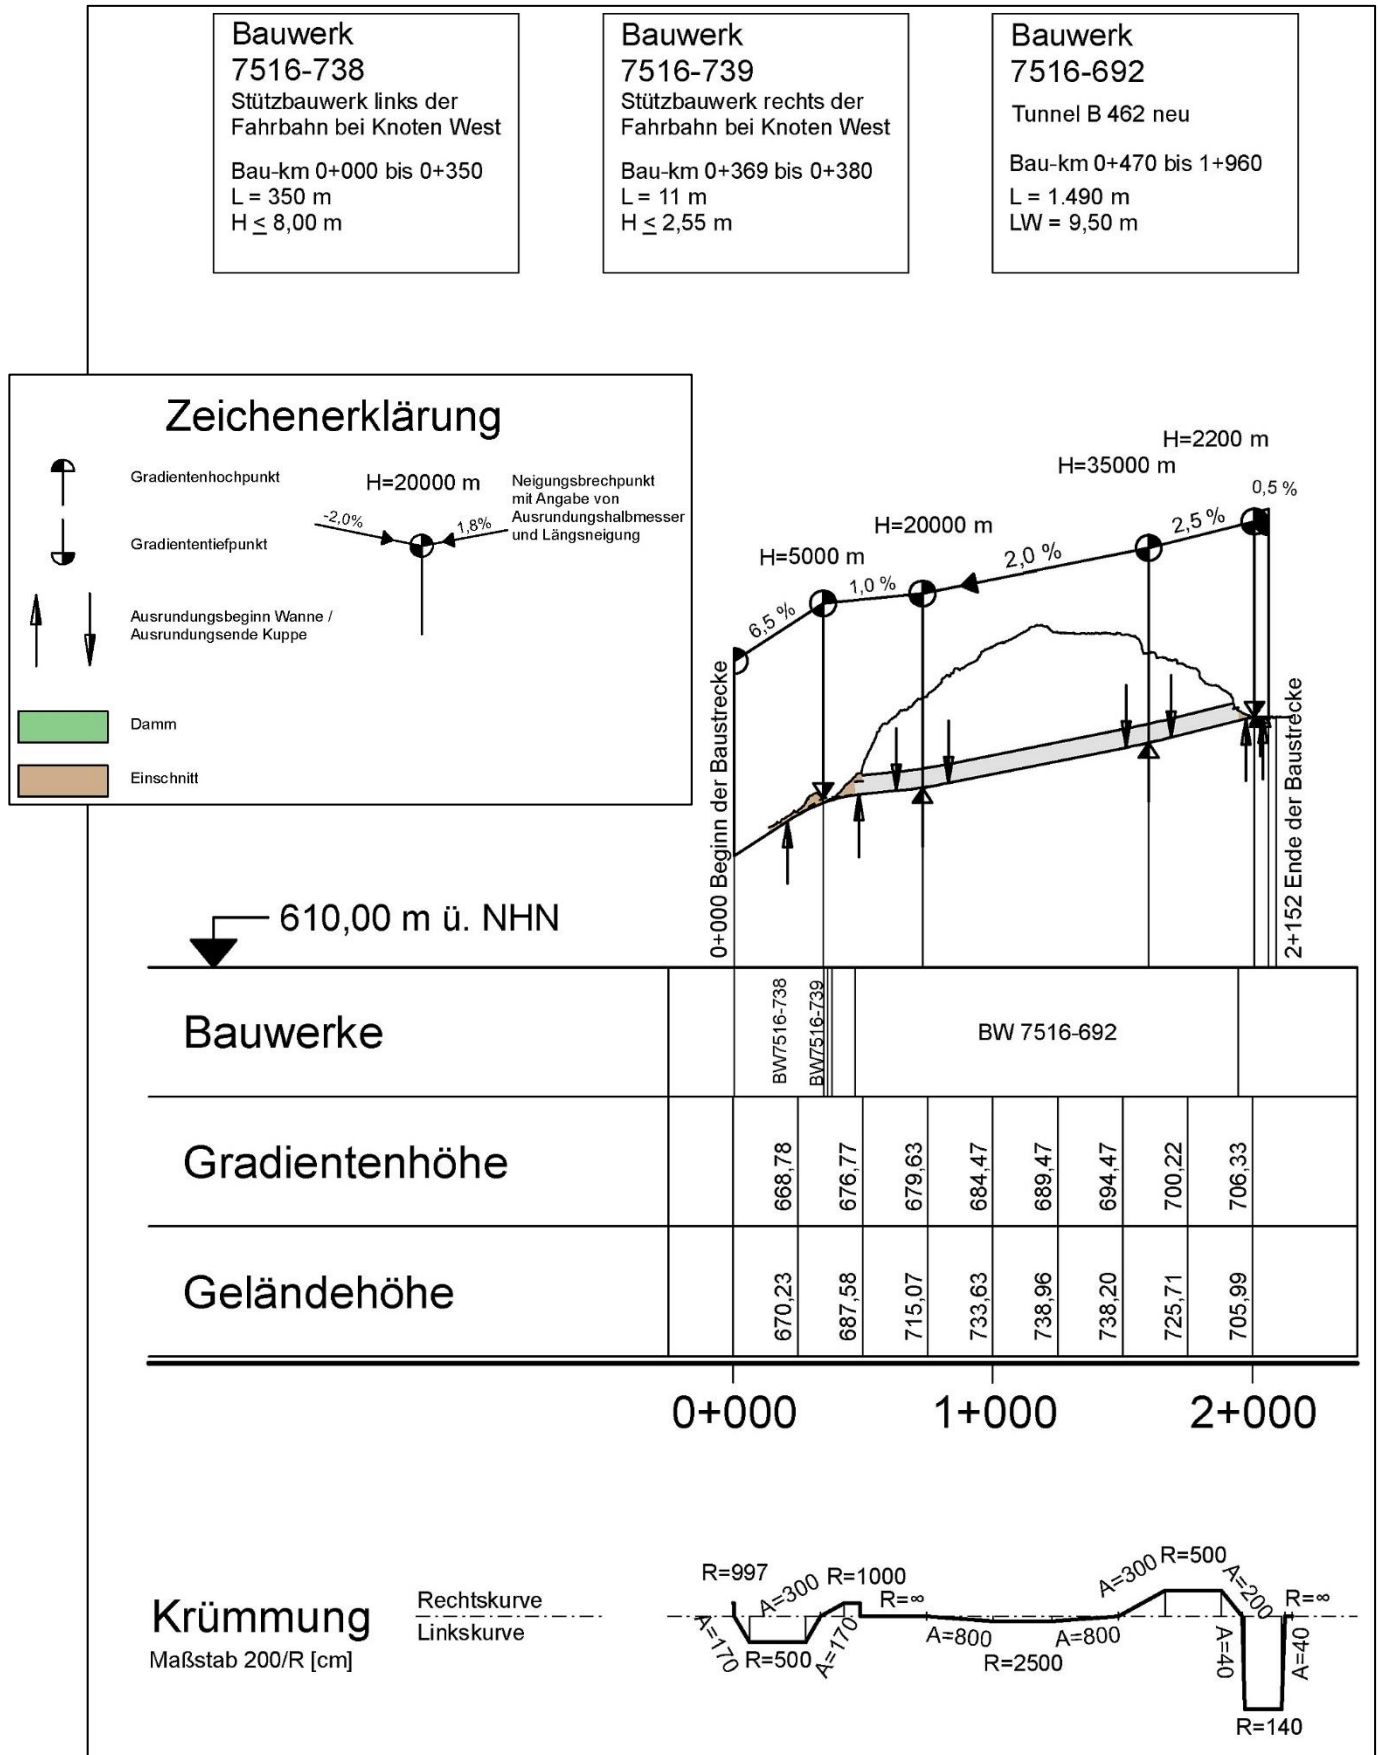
Übersichtshöhenplan (Feststellungsentwurf / Unterlage 4 / Plan 1)
